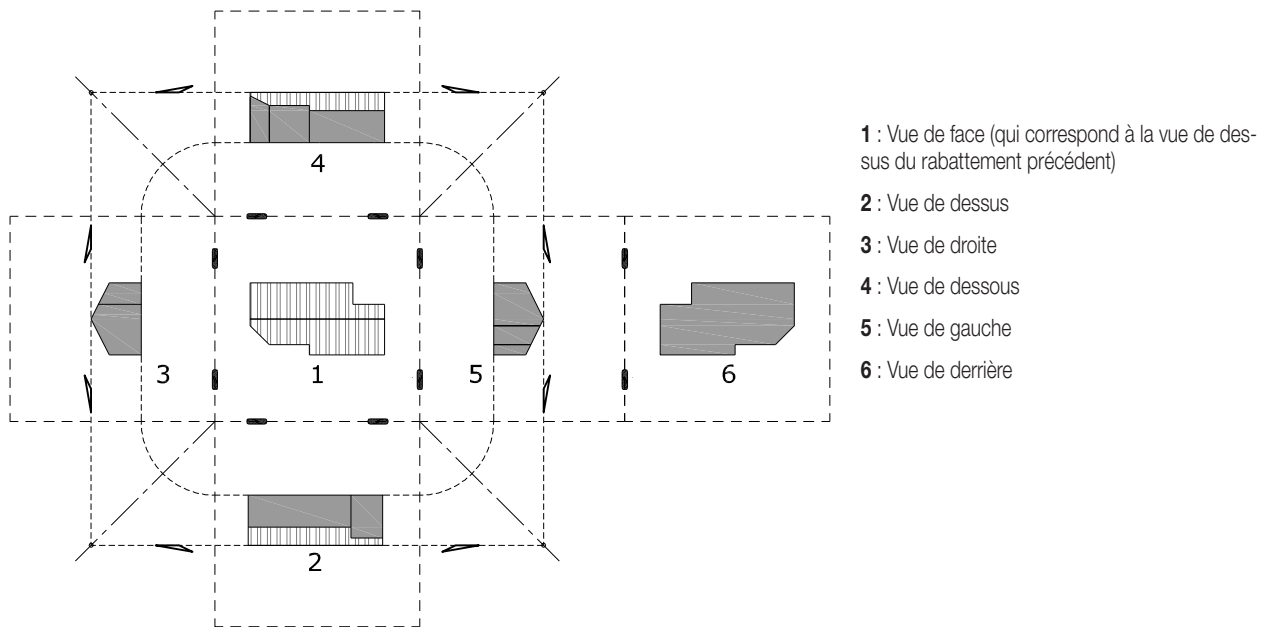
Déploiement du cube sur la base d'un plan horizontal
